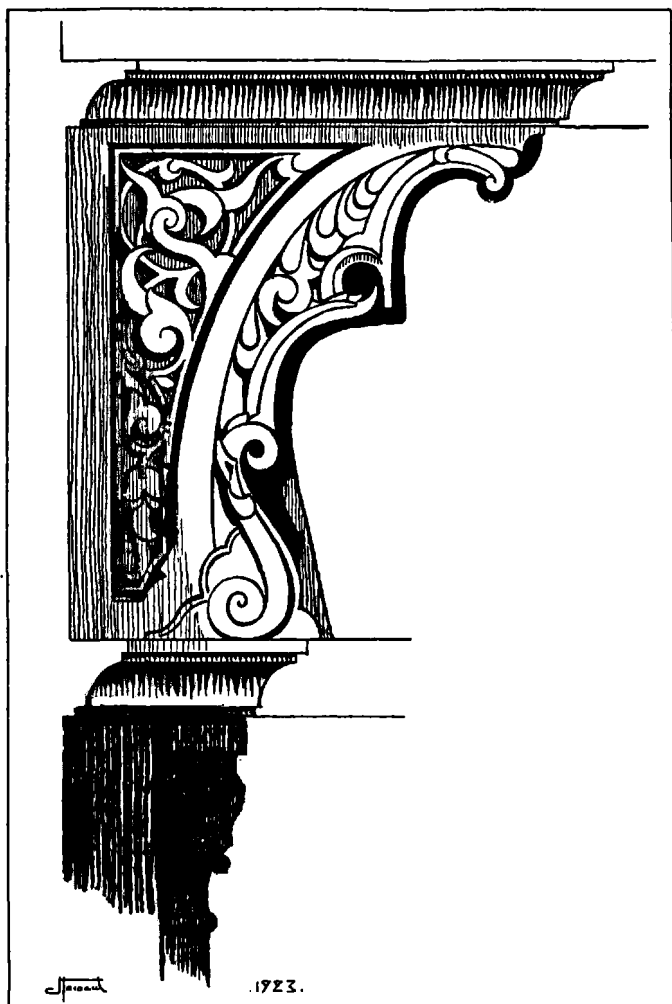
Porte de la Qasba des Oudaïa. Façade Sud : Console.
